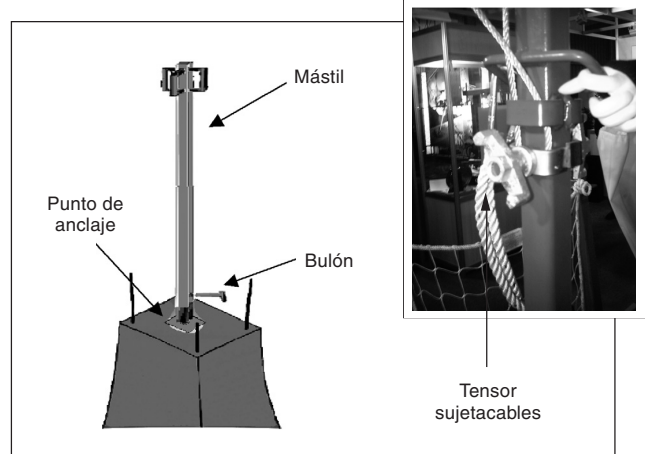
Montaje del mástil en el punto de anclaje y detalle del tensor sujetacables
